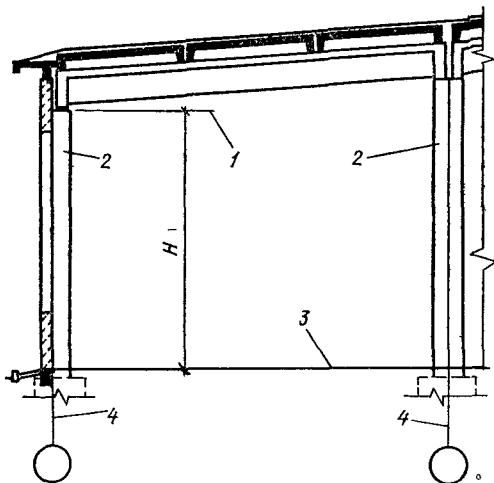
Высота крайних пролетов зданий без мостовых кранов при наружном отводе воды 1 — низ несущих конструкций покрытия, 2 — железобетонные колонны, 3 — уровень пола, 4 — разбивочная ось ряда, Н — высота помещения
